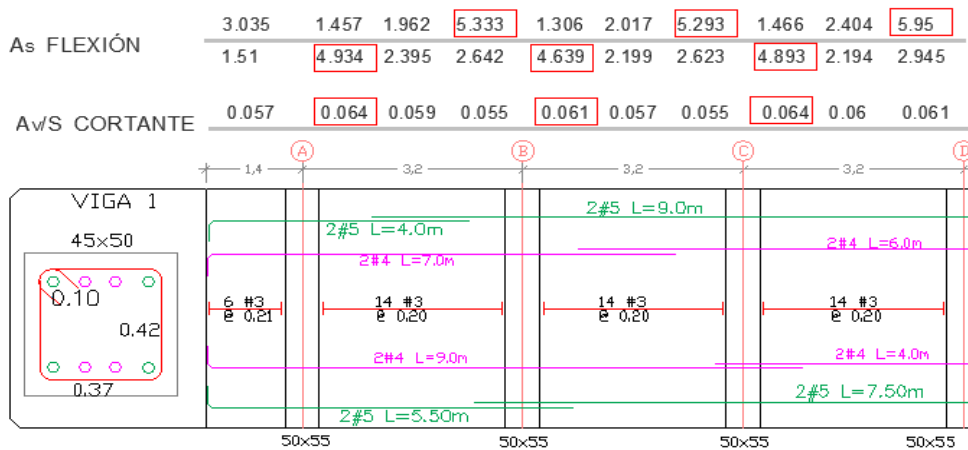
Cuantías obtenidas por esfuerzo a flexión, cortante y despiece de la viga 1 de la planta estructural. Fuente: elaboración propia.
